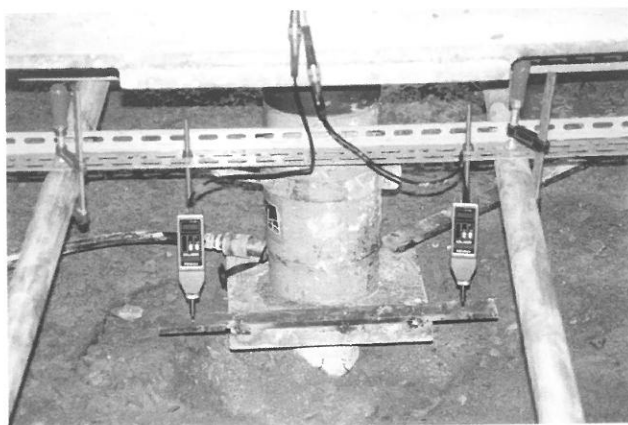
Particolare del martinetto e dei comparatori applicati in testa al micropalo
